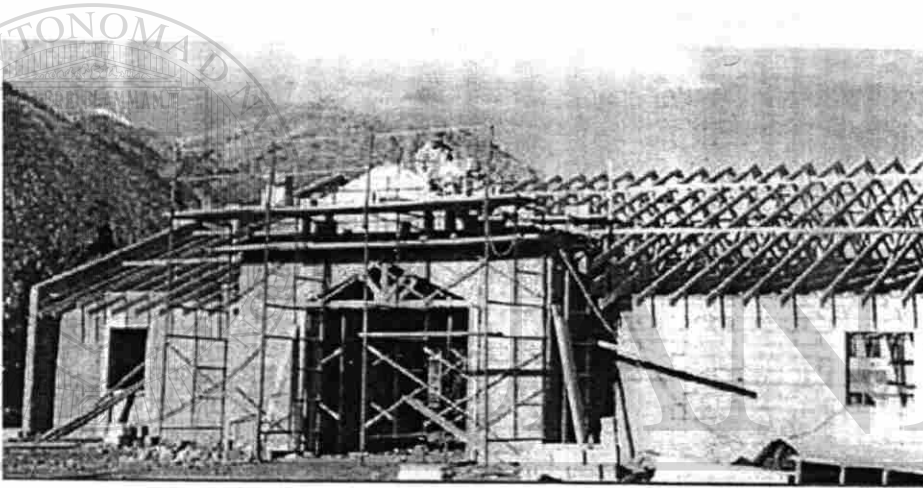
Construcción de un muro de mampostería sometido a carga axial y flexión.
